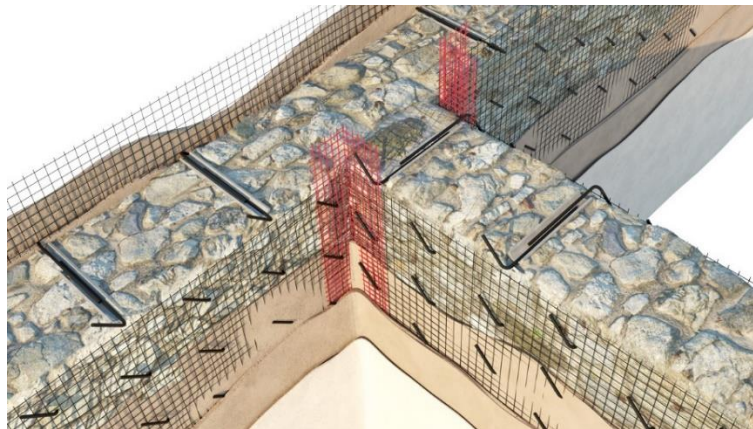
Esempio di rinforzo strutturale con intonaco armato - Tradimalt [11]
